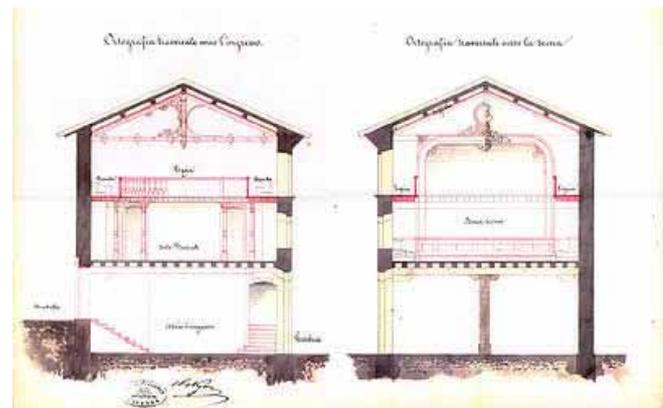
Projeto elaborado para o Teatro Jacquard, corte transversal da edificação.
